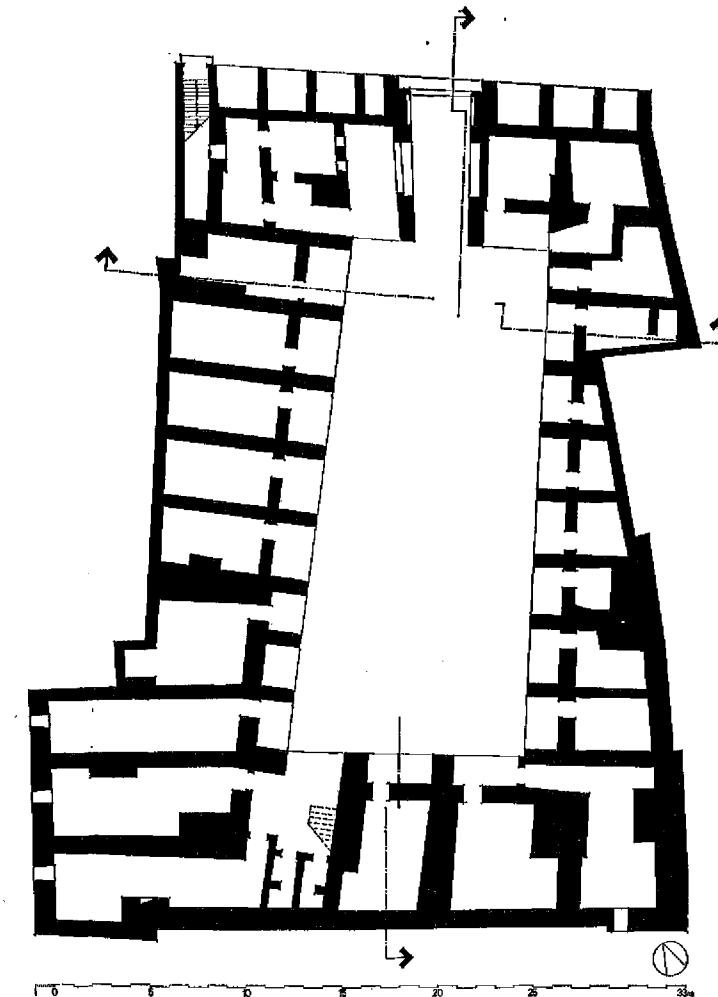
Kairo, Wakalat al-Bazar'a, Grundriß — Erdgeschoß
